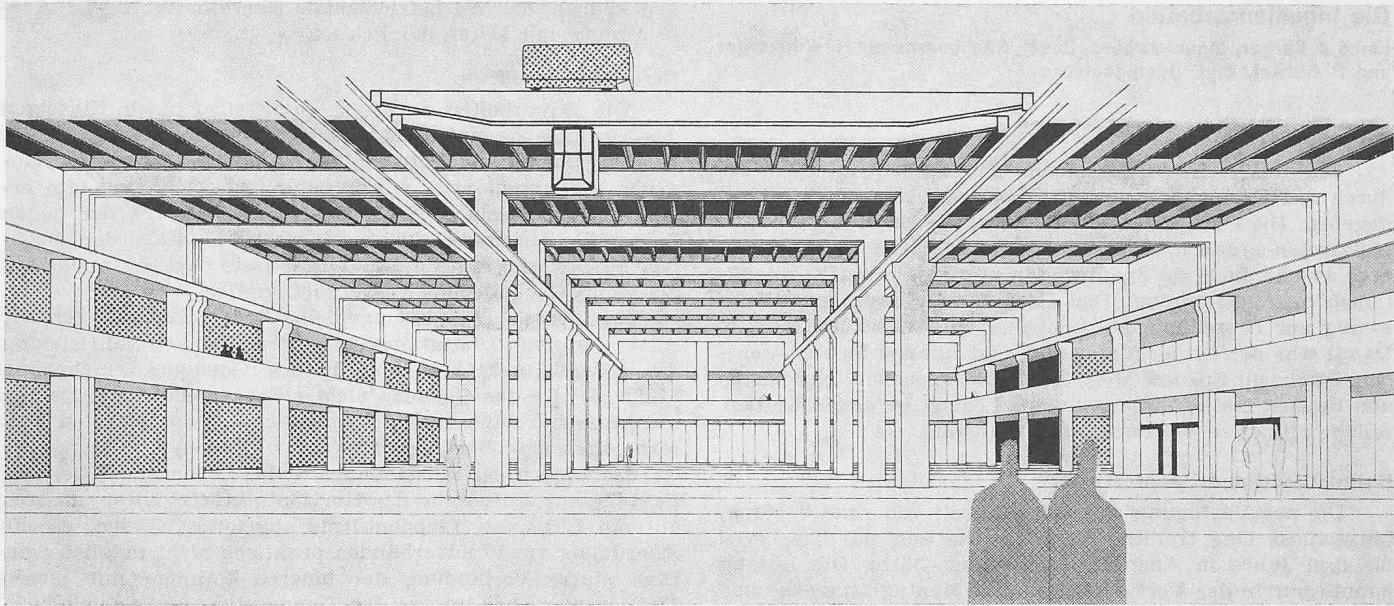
Haupthalle im Erdgeschoss (siehe auch Bild 11)
